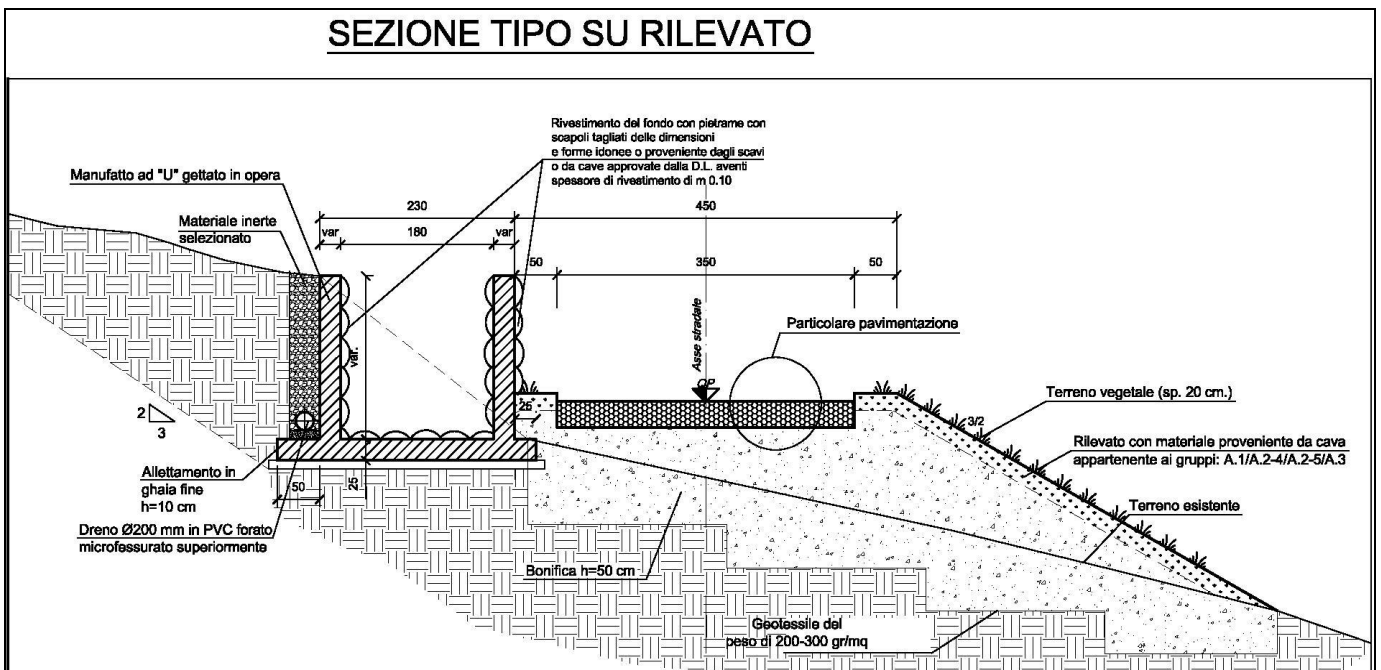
Viabilità di accesso abbacamento – Sezione tipo
